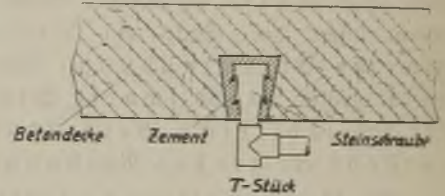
Rohrbefestigung mittels Stein-schraube in einer Betondecke.
